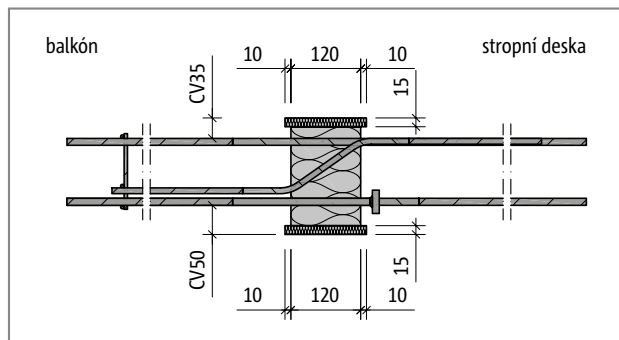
Schöck Isokorb® typ EXT50-R-V12: Půdorys prvku
